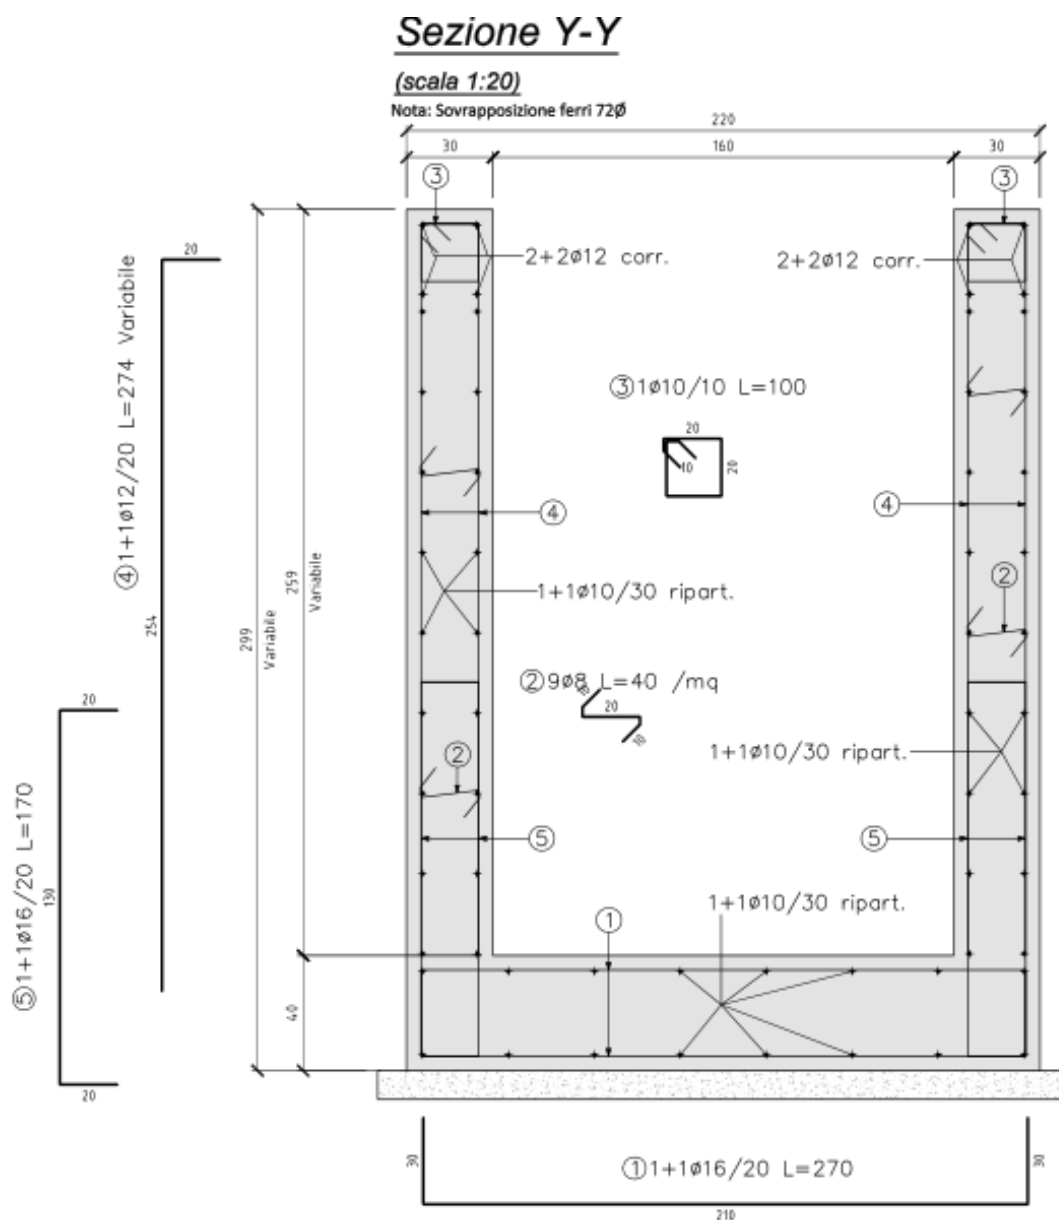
Armatura inserita sezione Y-Y (vedi tavola strutturale)
